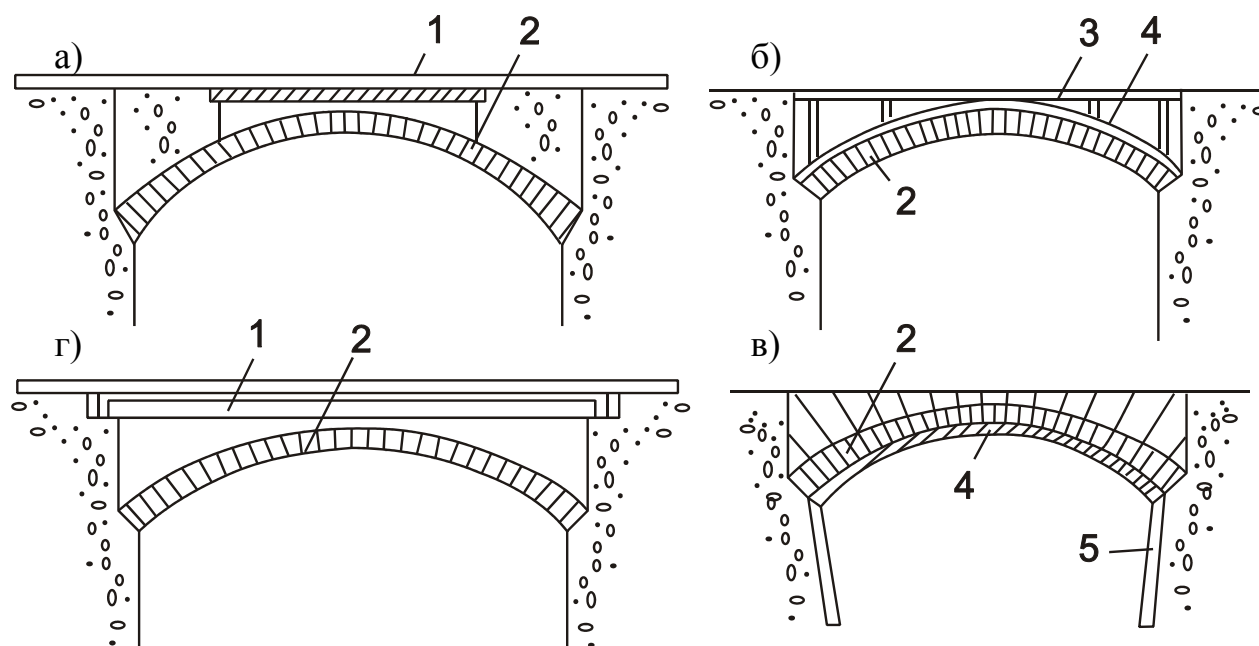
Схемы усиления сводов каменных и бетонных мостов: а – частичной или полной разгрузкой сводов; б – расположением дополнительного свода сверху существующего; в – то же, снизу существующего; г – путем устройства плитного пролетного строения; 1 – железобетонная плита; 2 – существующий свод; 3 – облегченное надсводное строение; 4 – свод усиления; 5 – уширение опоры
